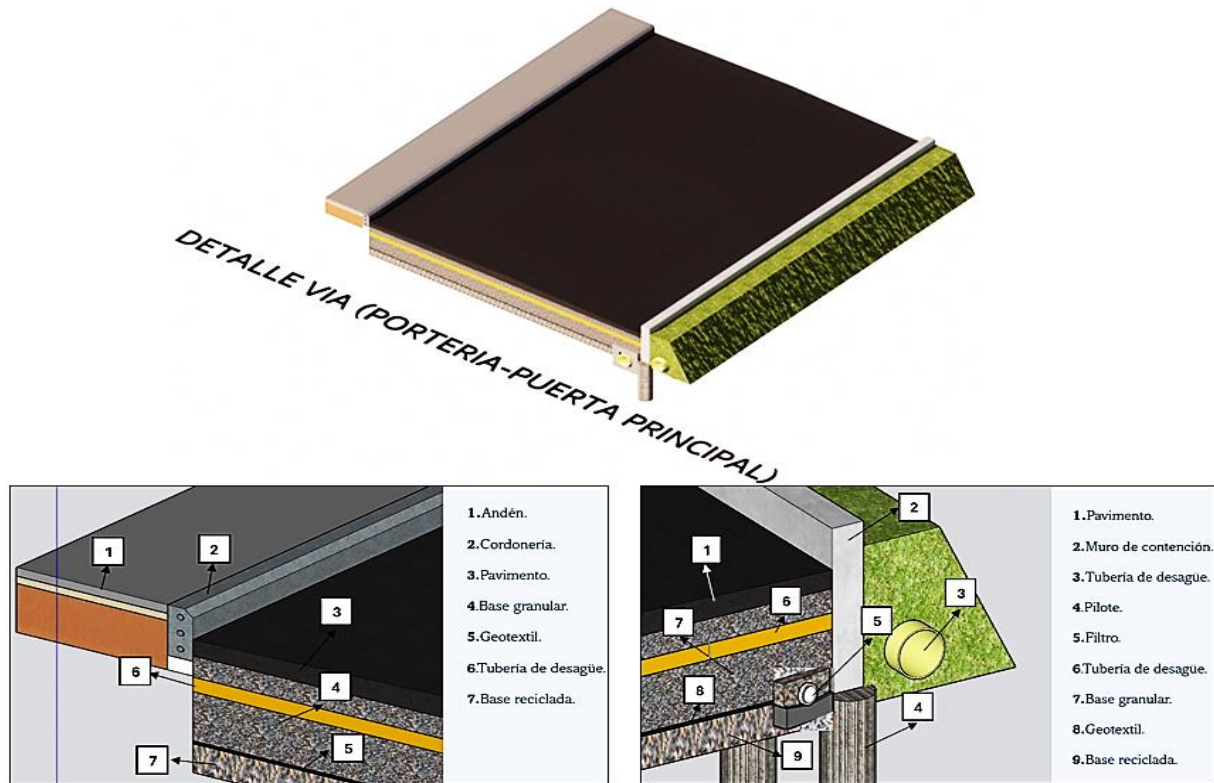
Detalles constructivos y elementos de vía (sección 1). Fuente: elaboración propia.
